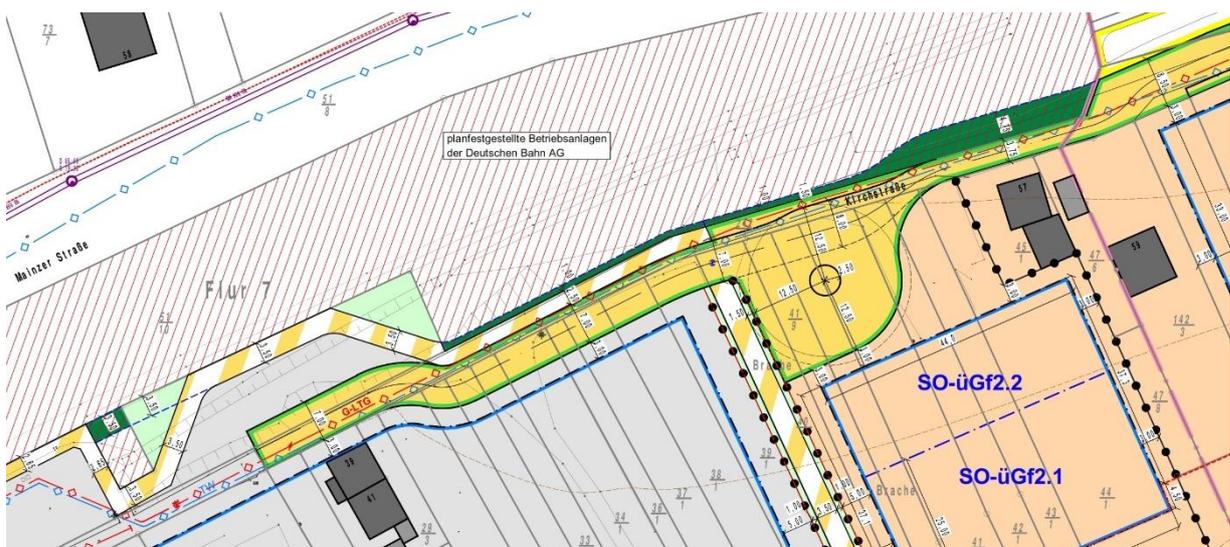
Lageplan mit möglicher Planungsvariante der Straßenverkehrs-, Geh- und Radwegeführung im Bereich bahneigener Flächen
